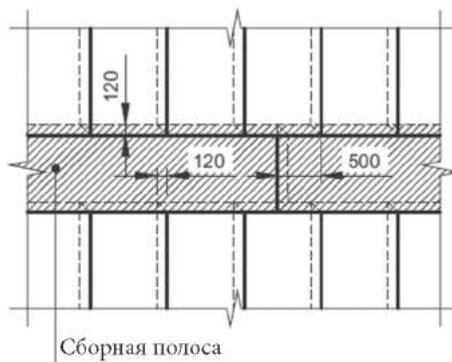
Устройство однослойного гидроизоляционного покрытия методом *сборной полосы
